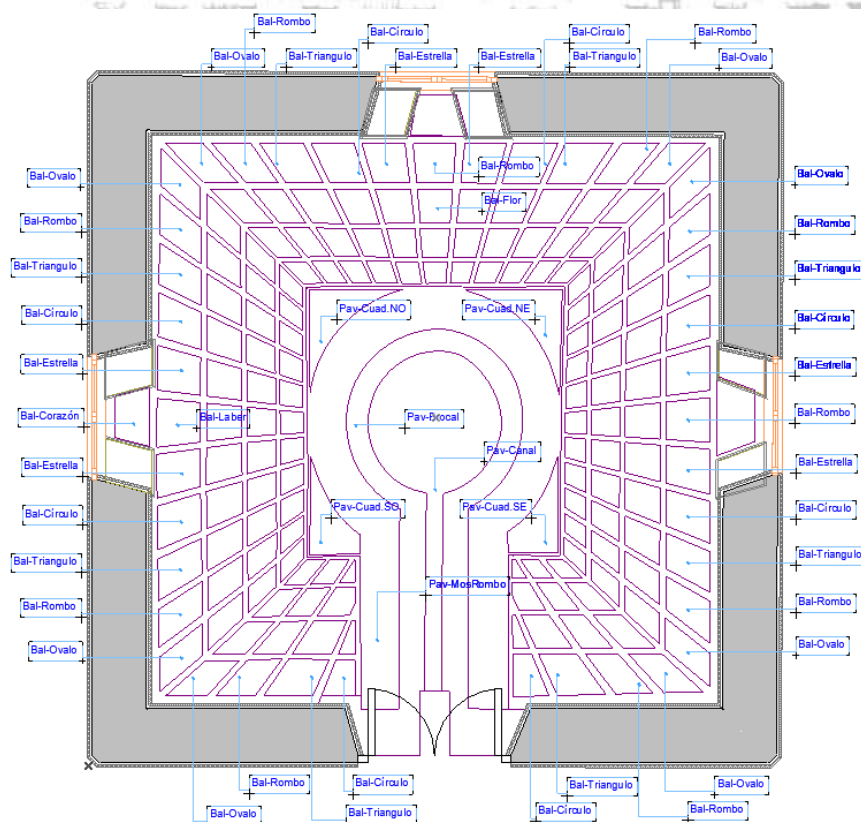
Vista 2D de la Planta Contorneada con las etiquetas de sectores y piezas identificadas. ArchiCAD 17.
